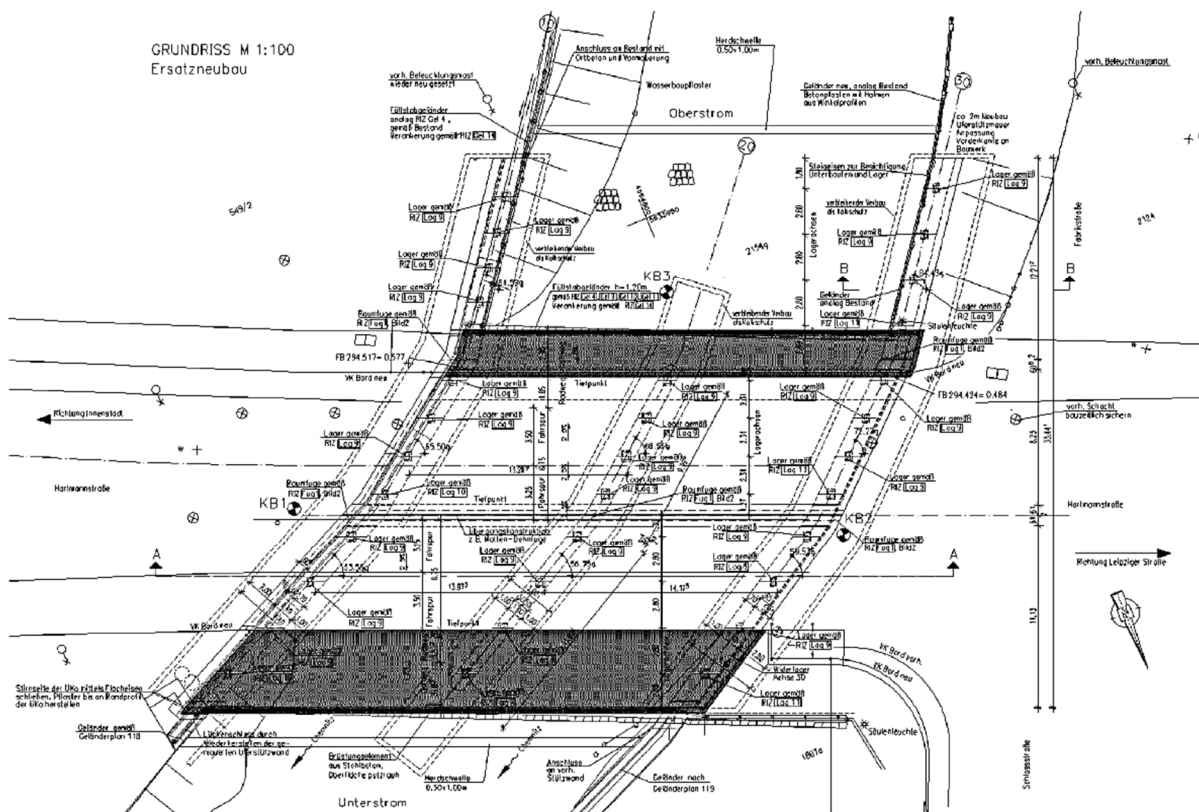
Brücke Hartmannstraße; Bestand - Grundriss³
